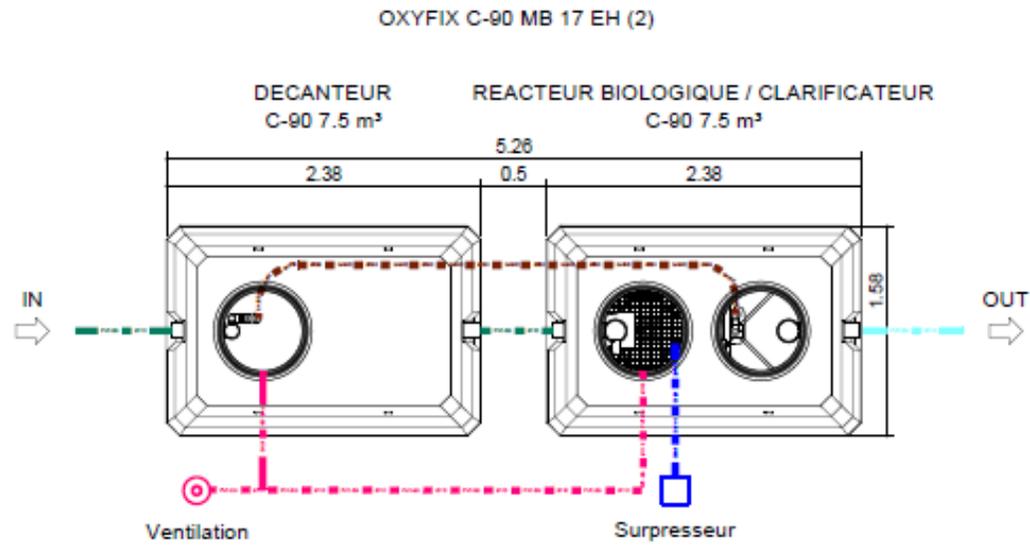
plan d'encombrement de l'oxyfix® C-90 17 EH
